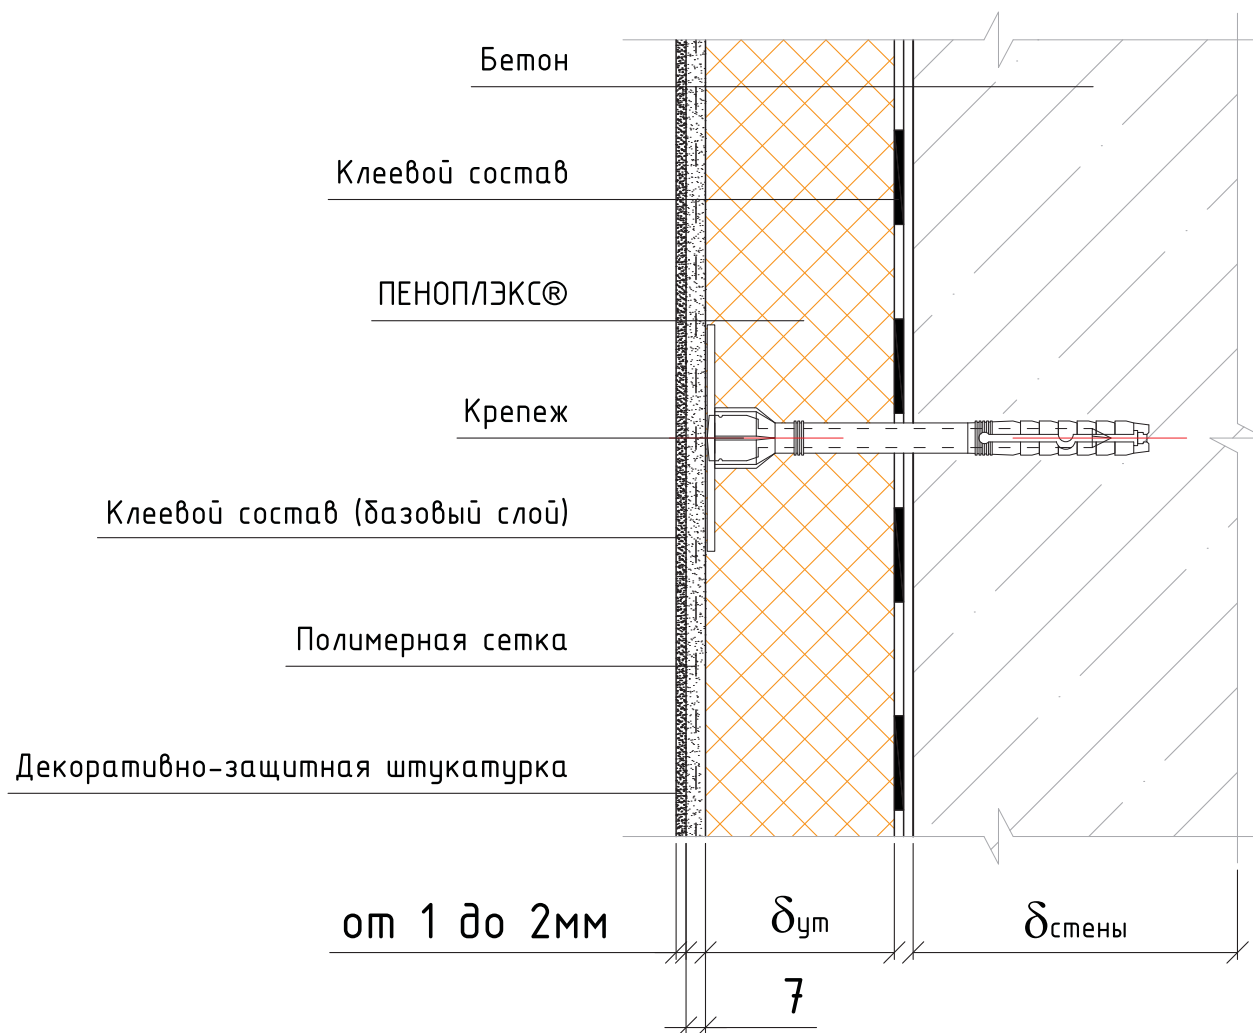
Схема конструкции стены первого или цокольного этажа №1
